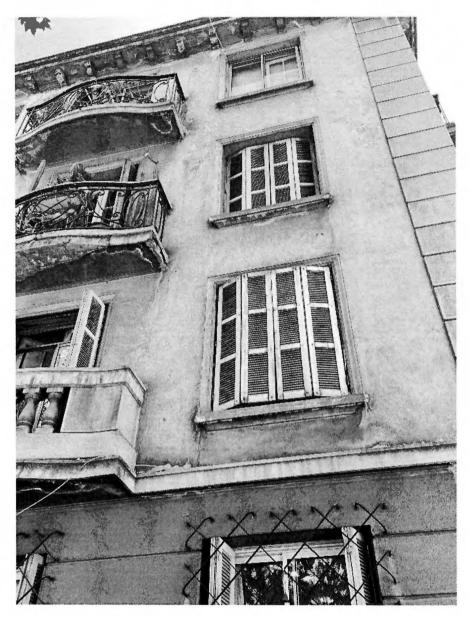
Daño típico fisuras en muros y marquesinas de ventanas, fachada oeste.
